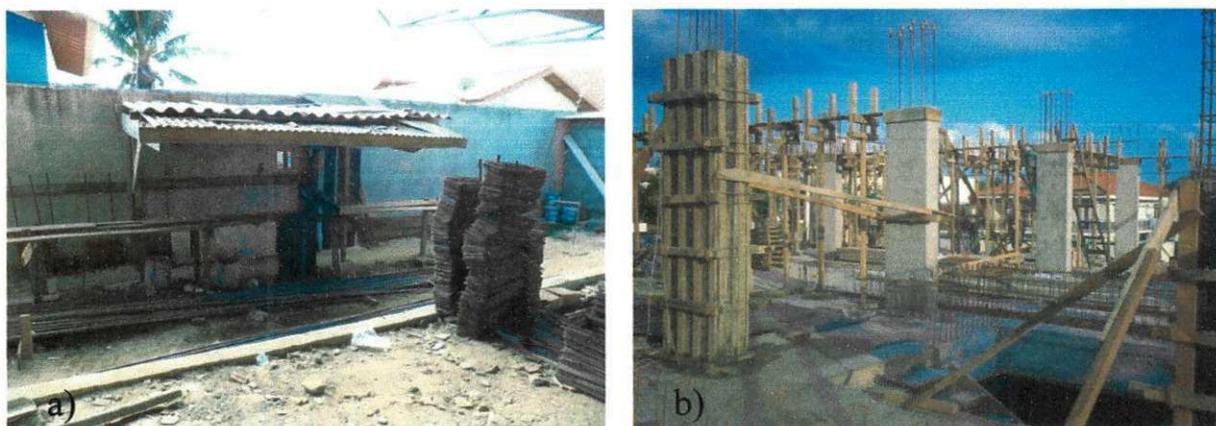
a) Local do canteiro reservado para confecção da armadura; b) Disposição das esperas das vigas e das formas de madeira.
